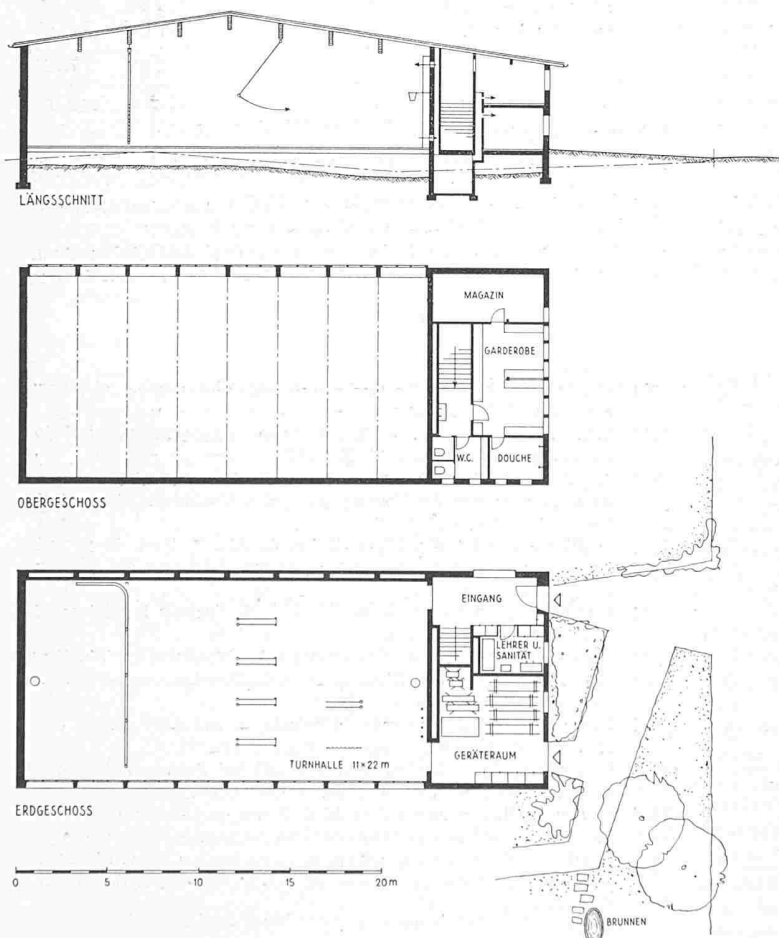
Längsschnitt und Grundrisse 1:400
